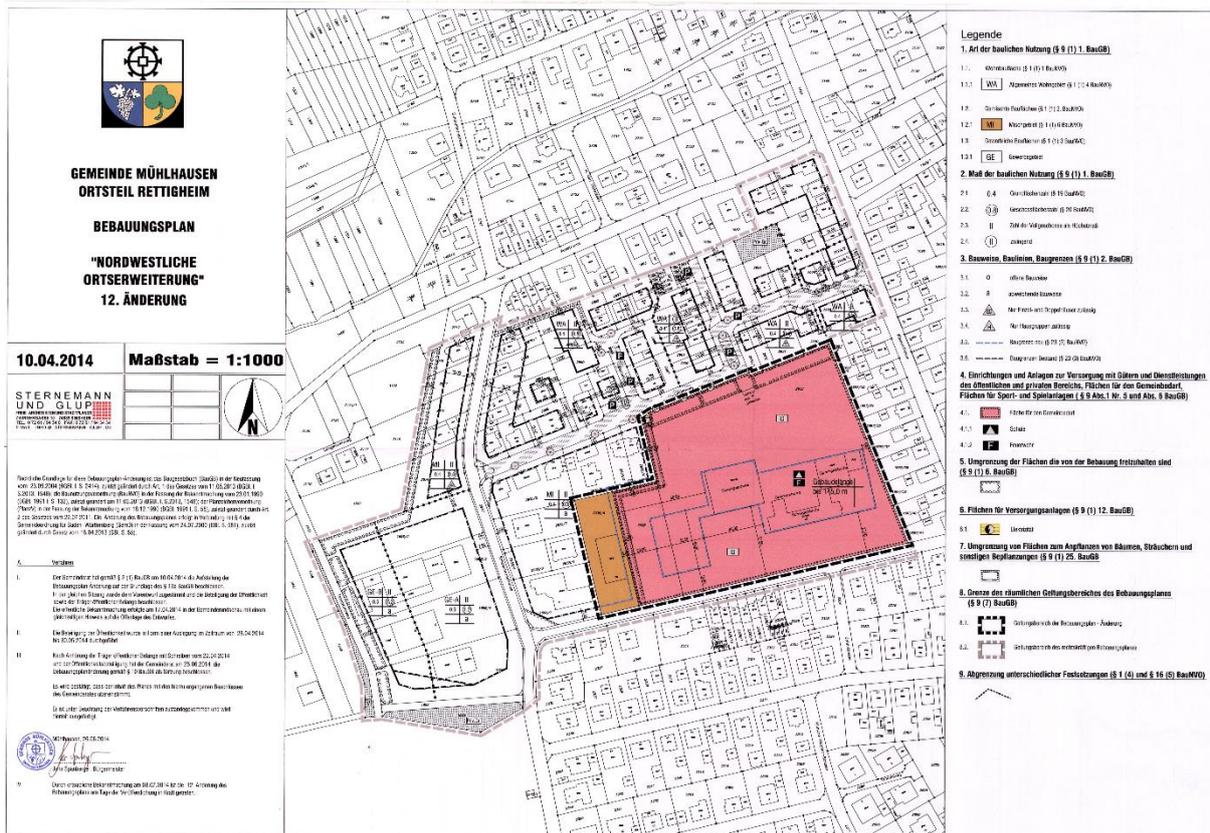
Bebauungsplan „Nordwestliche Ortserweiterung“ 12. Teiländerung.
